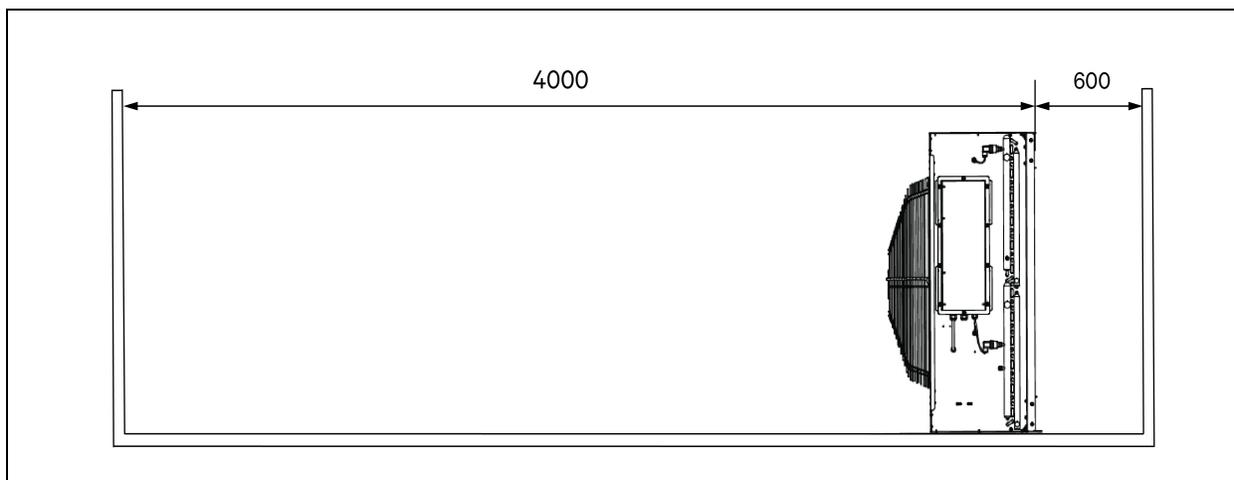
Requisiti di spazio per l'installazione verticale (unità: mm)
